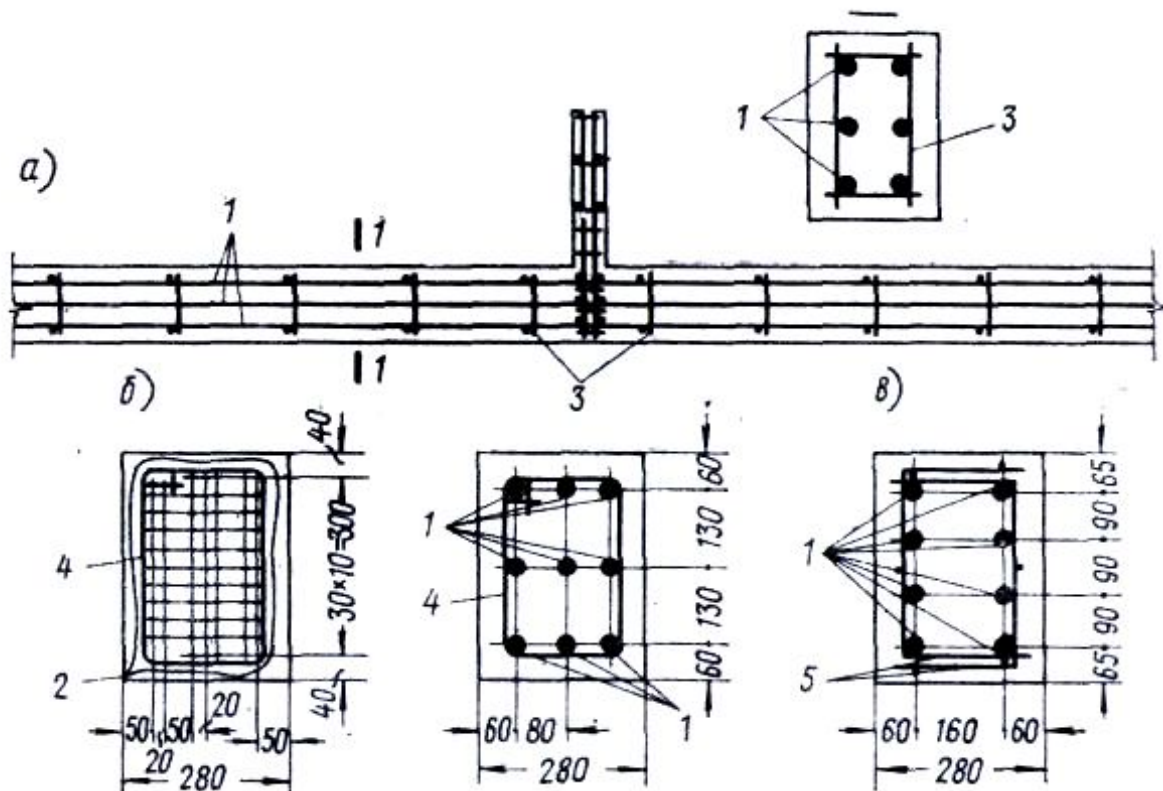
Схема розташування арматури в нижньому поясі ферми
